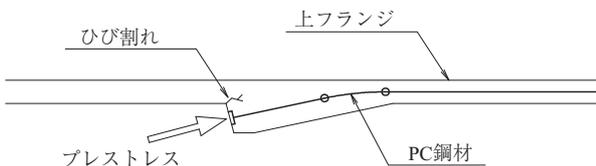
フランジに定着を設けた時のひび割れ
